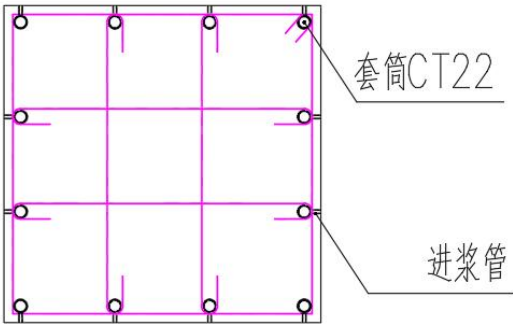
预制柱套筒进浆孔布置示意图
